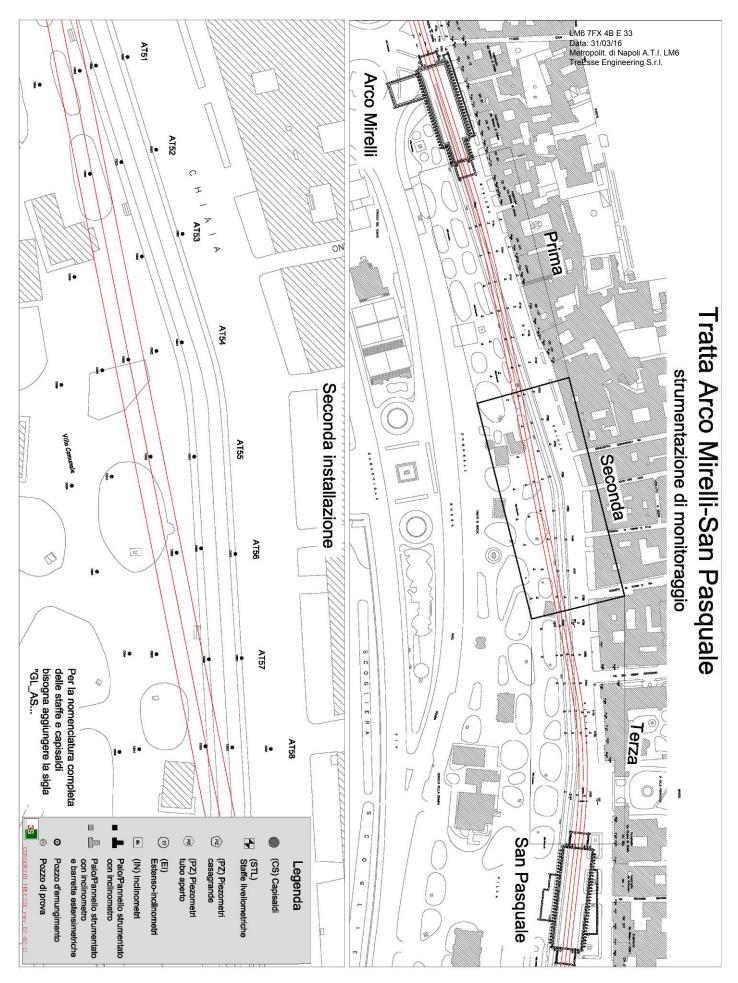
Planimetria tratta Arco Mirelli-SanPasquale, raffigurante la disposizione della seconda installazione della strumentazione di monitoraggio.
